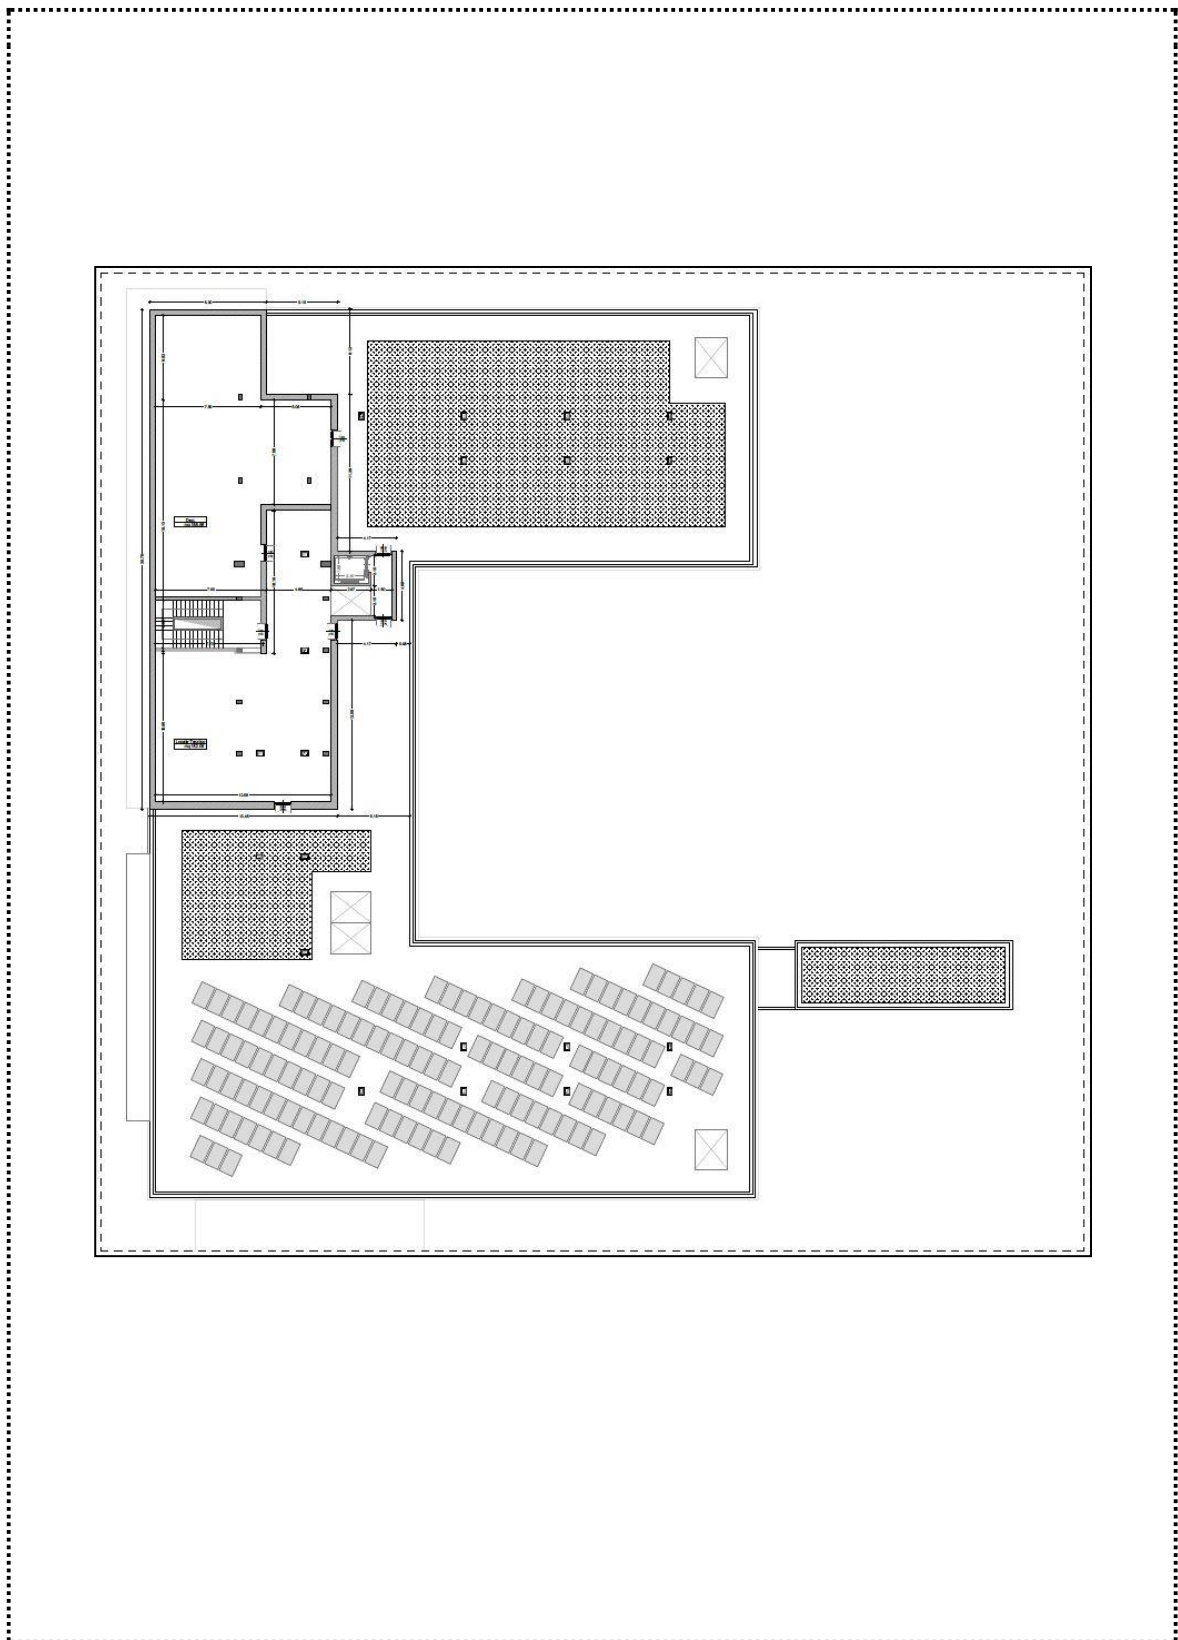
Estratti tavole di progetto – pianta piano locale tecnico RSA (T.10)
